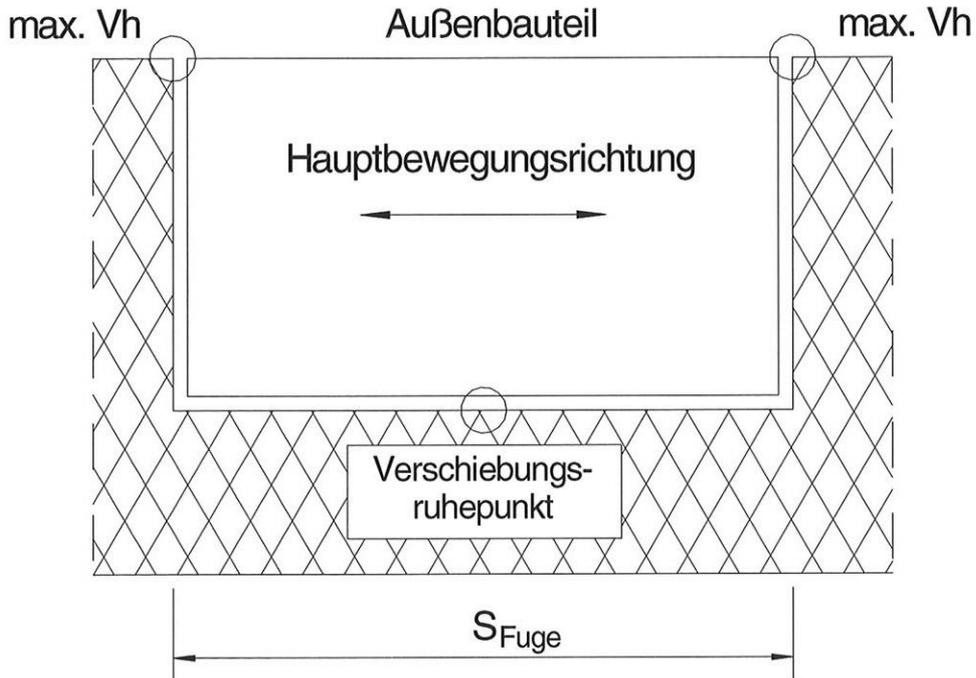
Einbausituation mit Lagerung an gegenüberliegenden Rändern
